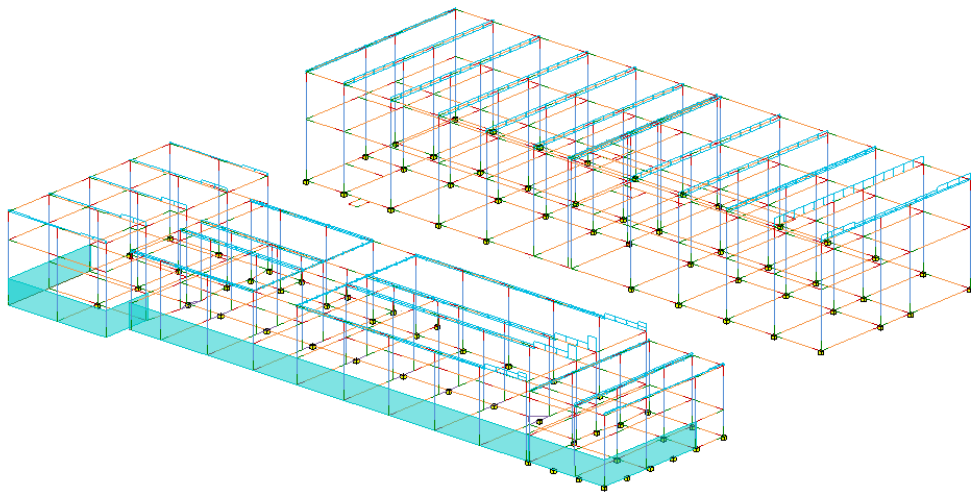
Vista 3D del modelo analítico con las cargas de viento oeste sobre cubierta
